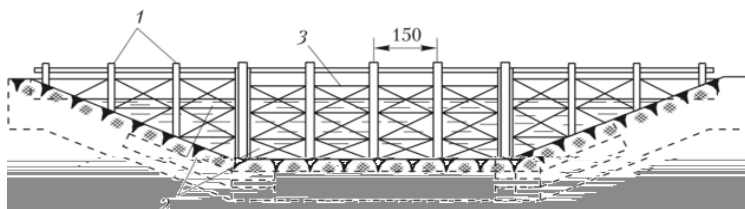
Железобетонная верховина: 1 – стойки; 2 – щиты; 3 – решетки
